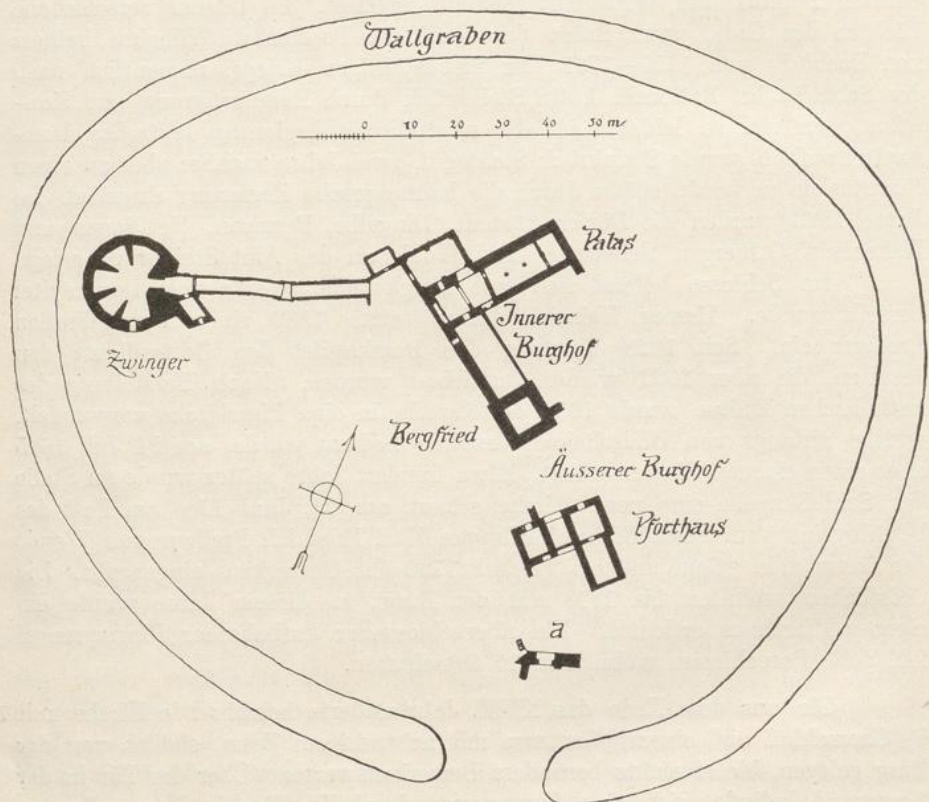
Burgruine Steinbrück; Lageplan (Maßstab 1:1500).
